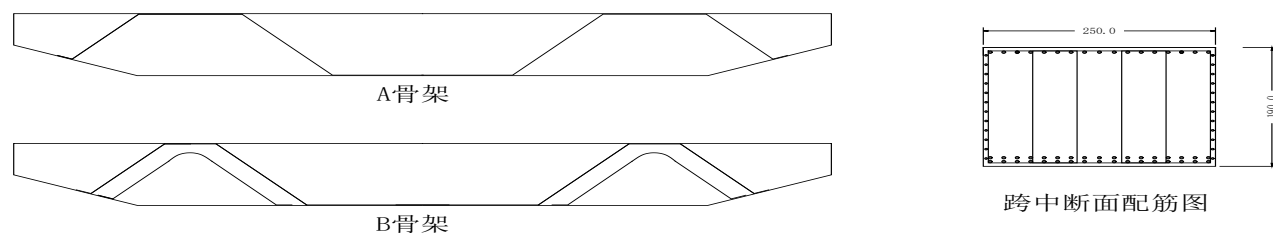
非预应力钢筋混凝土盖梁配筋断面示意图
